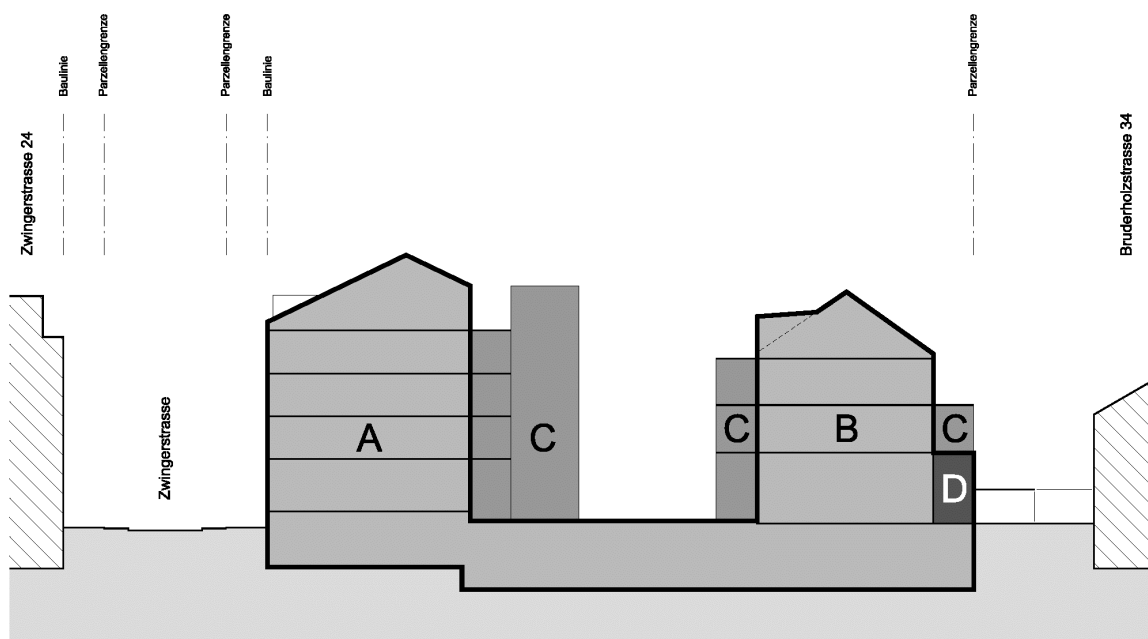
Plan-Nr. 13'189. Bebauungsplan: Schnitt. (kein Massstab)
